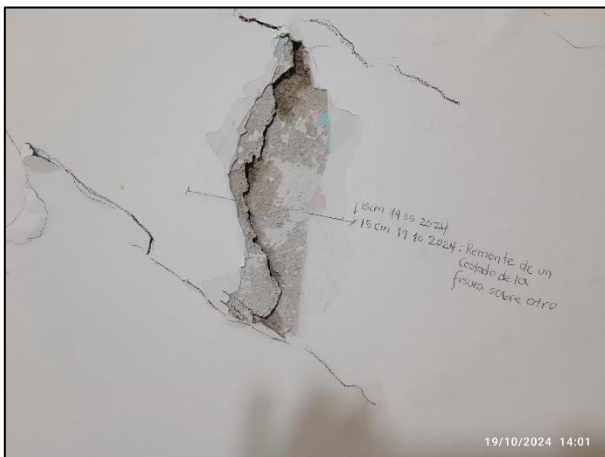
Grieta y descascaramiento en muro 1.
